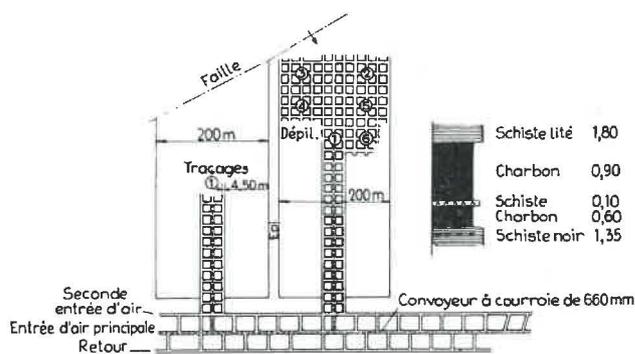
Schéma général de découpe du gisement avec panneaux en traçages et en défilage.
